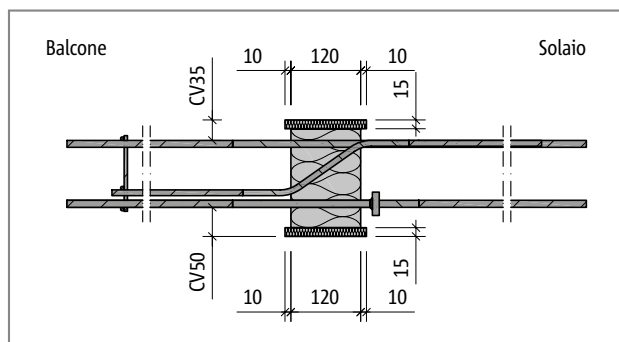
Schöck Isokorb® tipo EXT30-CV35, REI120: sezione dell'elemento
